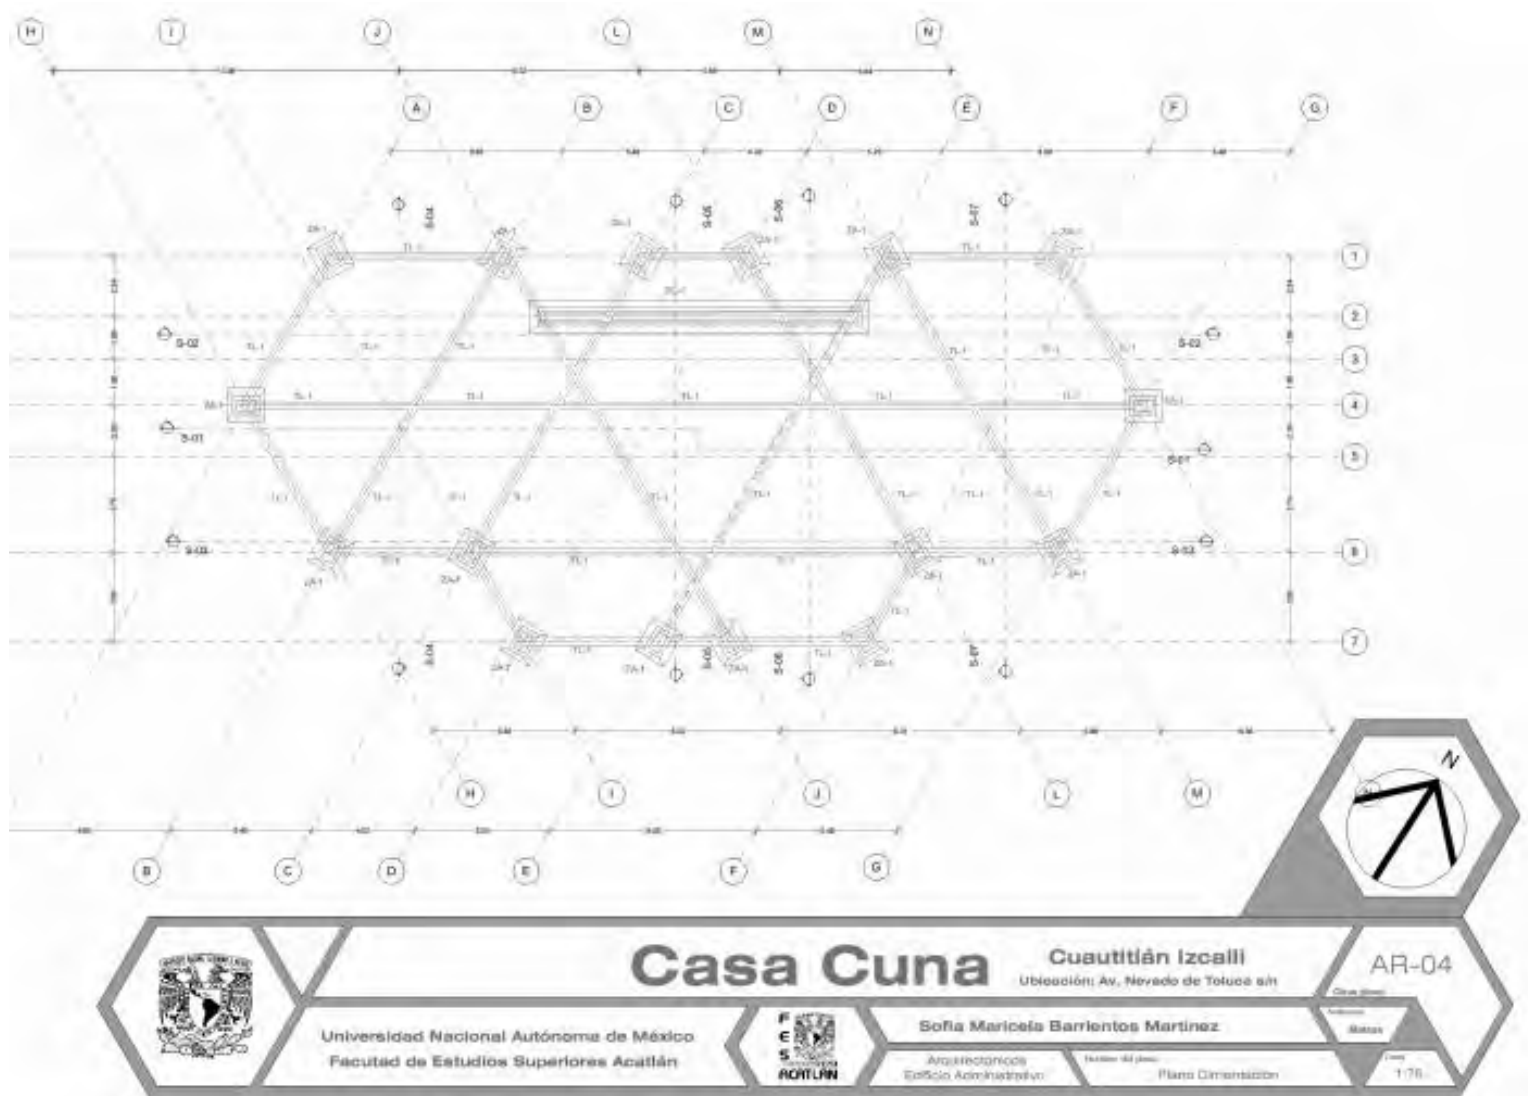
Plano de cimentación, zapatas y traves de liga (dibujo en CAD)
